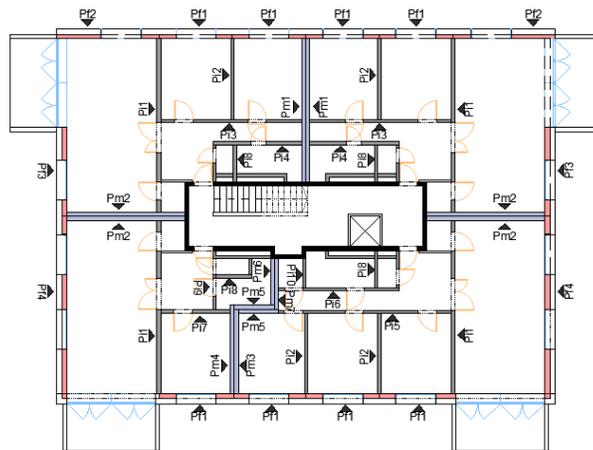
Caso 2. Res. Passivhouse. Modulación de muros interiores. Fuente: Elaboración propia.
